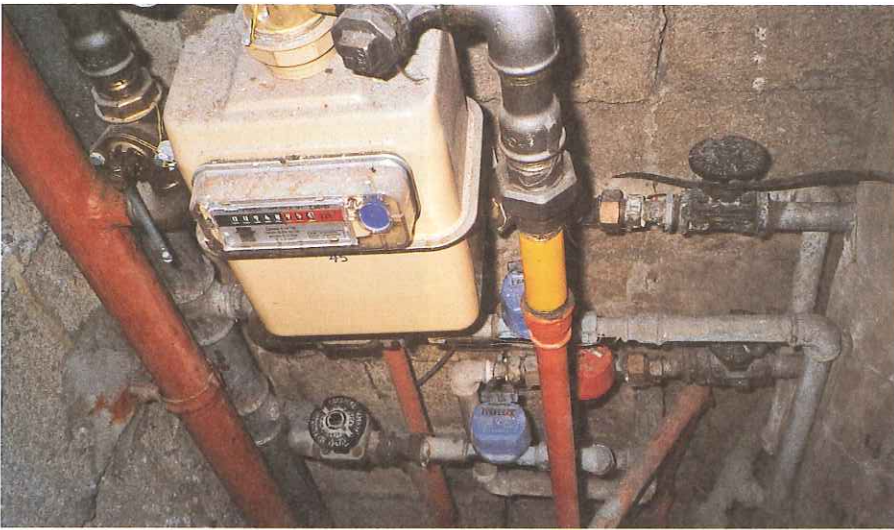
Open verticale koker voor aardgas- en watervoorziening.
